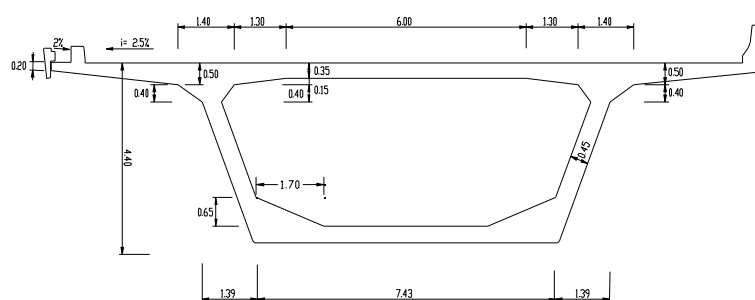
Corte transversal do tabuleiro sobre os pilares P14 e P15.
